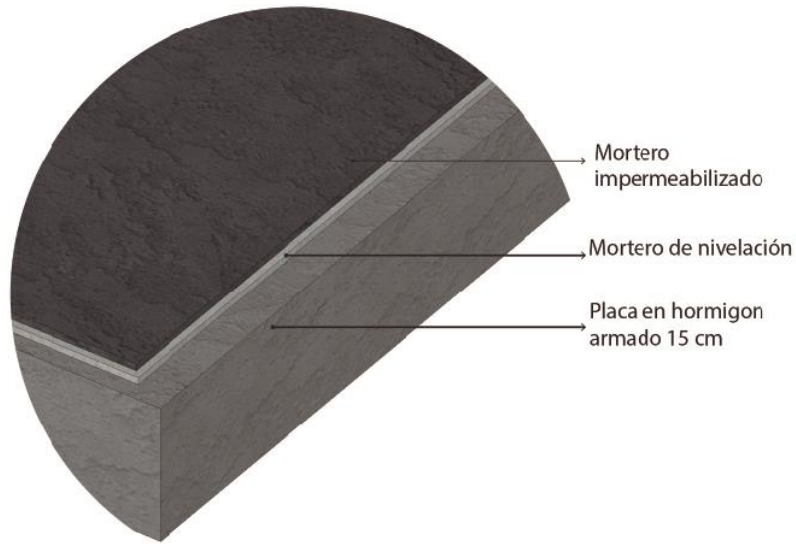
Detalle constructivo típico de una placa de cubierta maciza en concreto Fuente: elaboración propia
